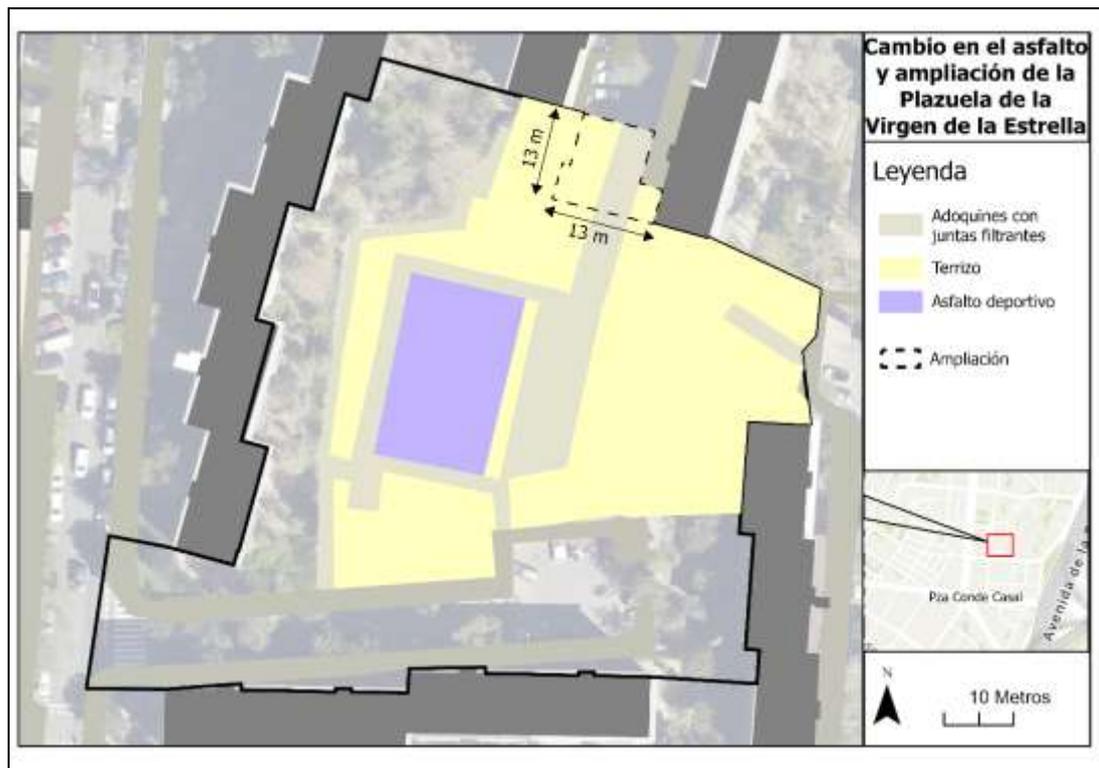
Plano del pavimento y la ampliación propuesta para el espacio. Fuente: Elaboración propia.
